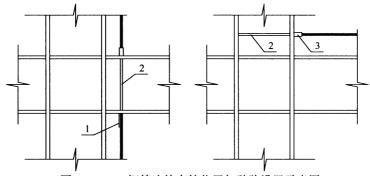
钢筋连接套筒位置加劲肋设置示意图 1一连接钢板,2一加劲肋,3一可焊钢筋连接套筒
